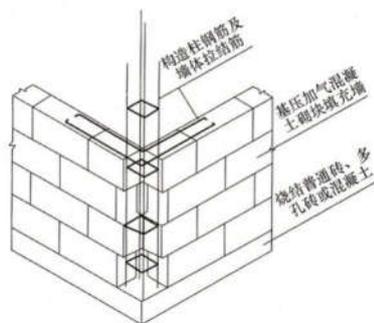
蒸压加气混凝土砌块填充墙构造柱
